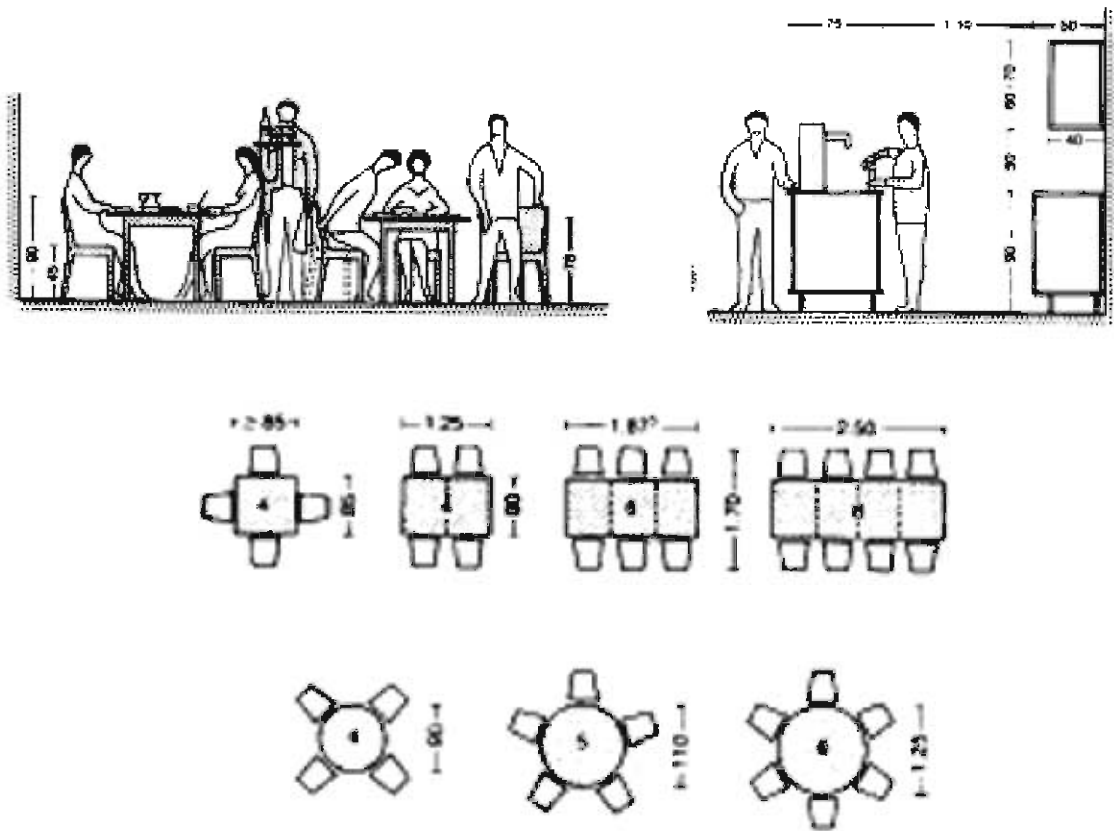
Dimensiones de mesas, sillas y cajas en planta y alzado
